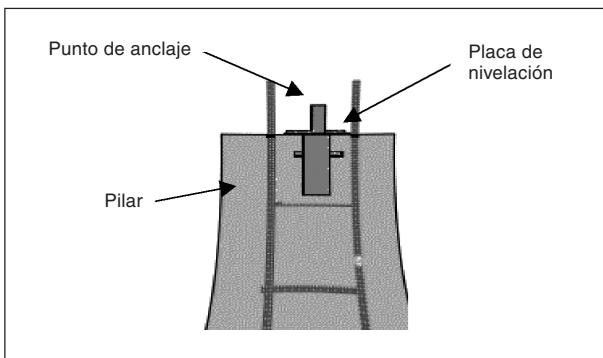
Detalle del punto de anclaje instalado sobre el pilar
